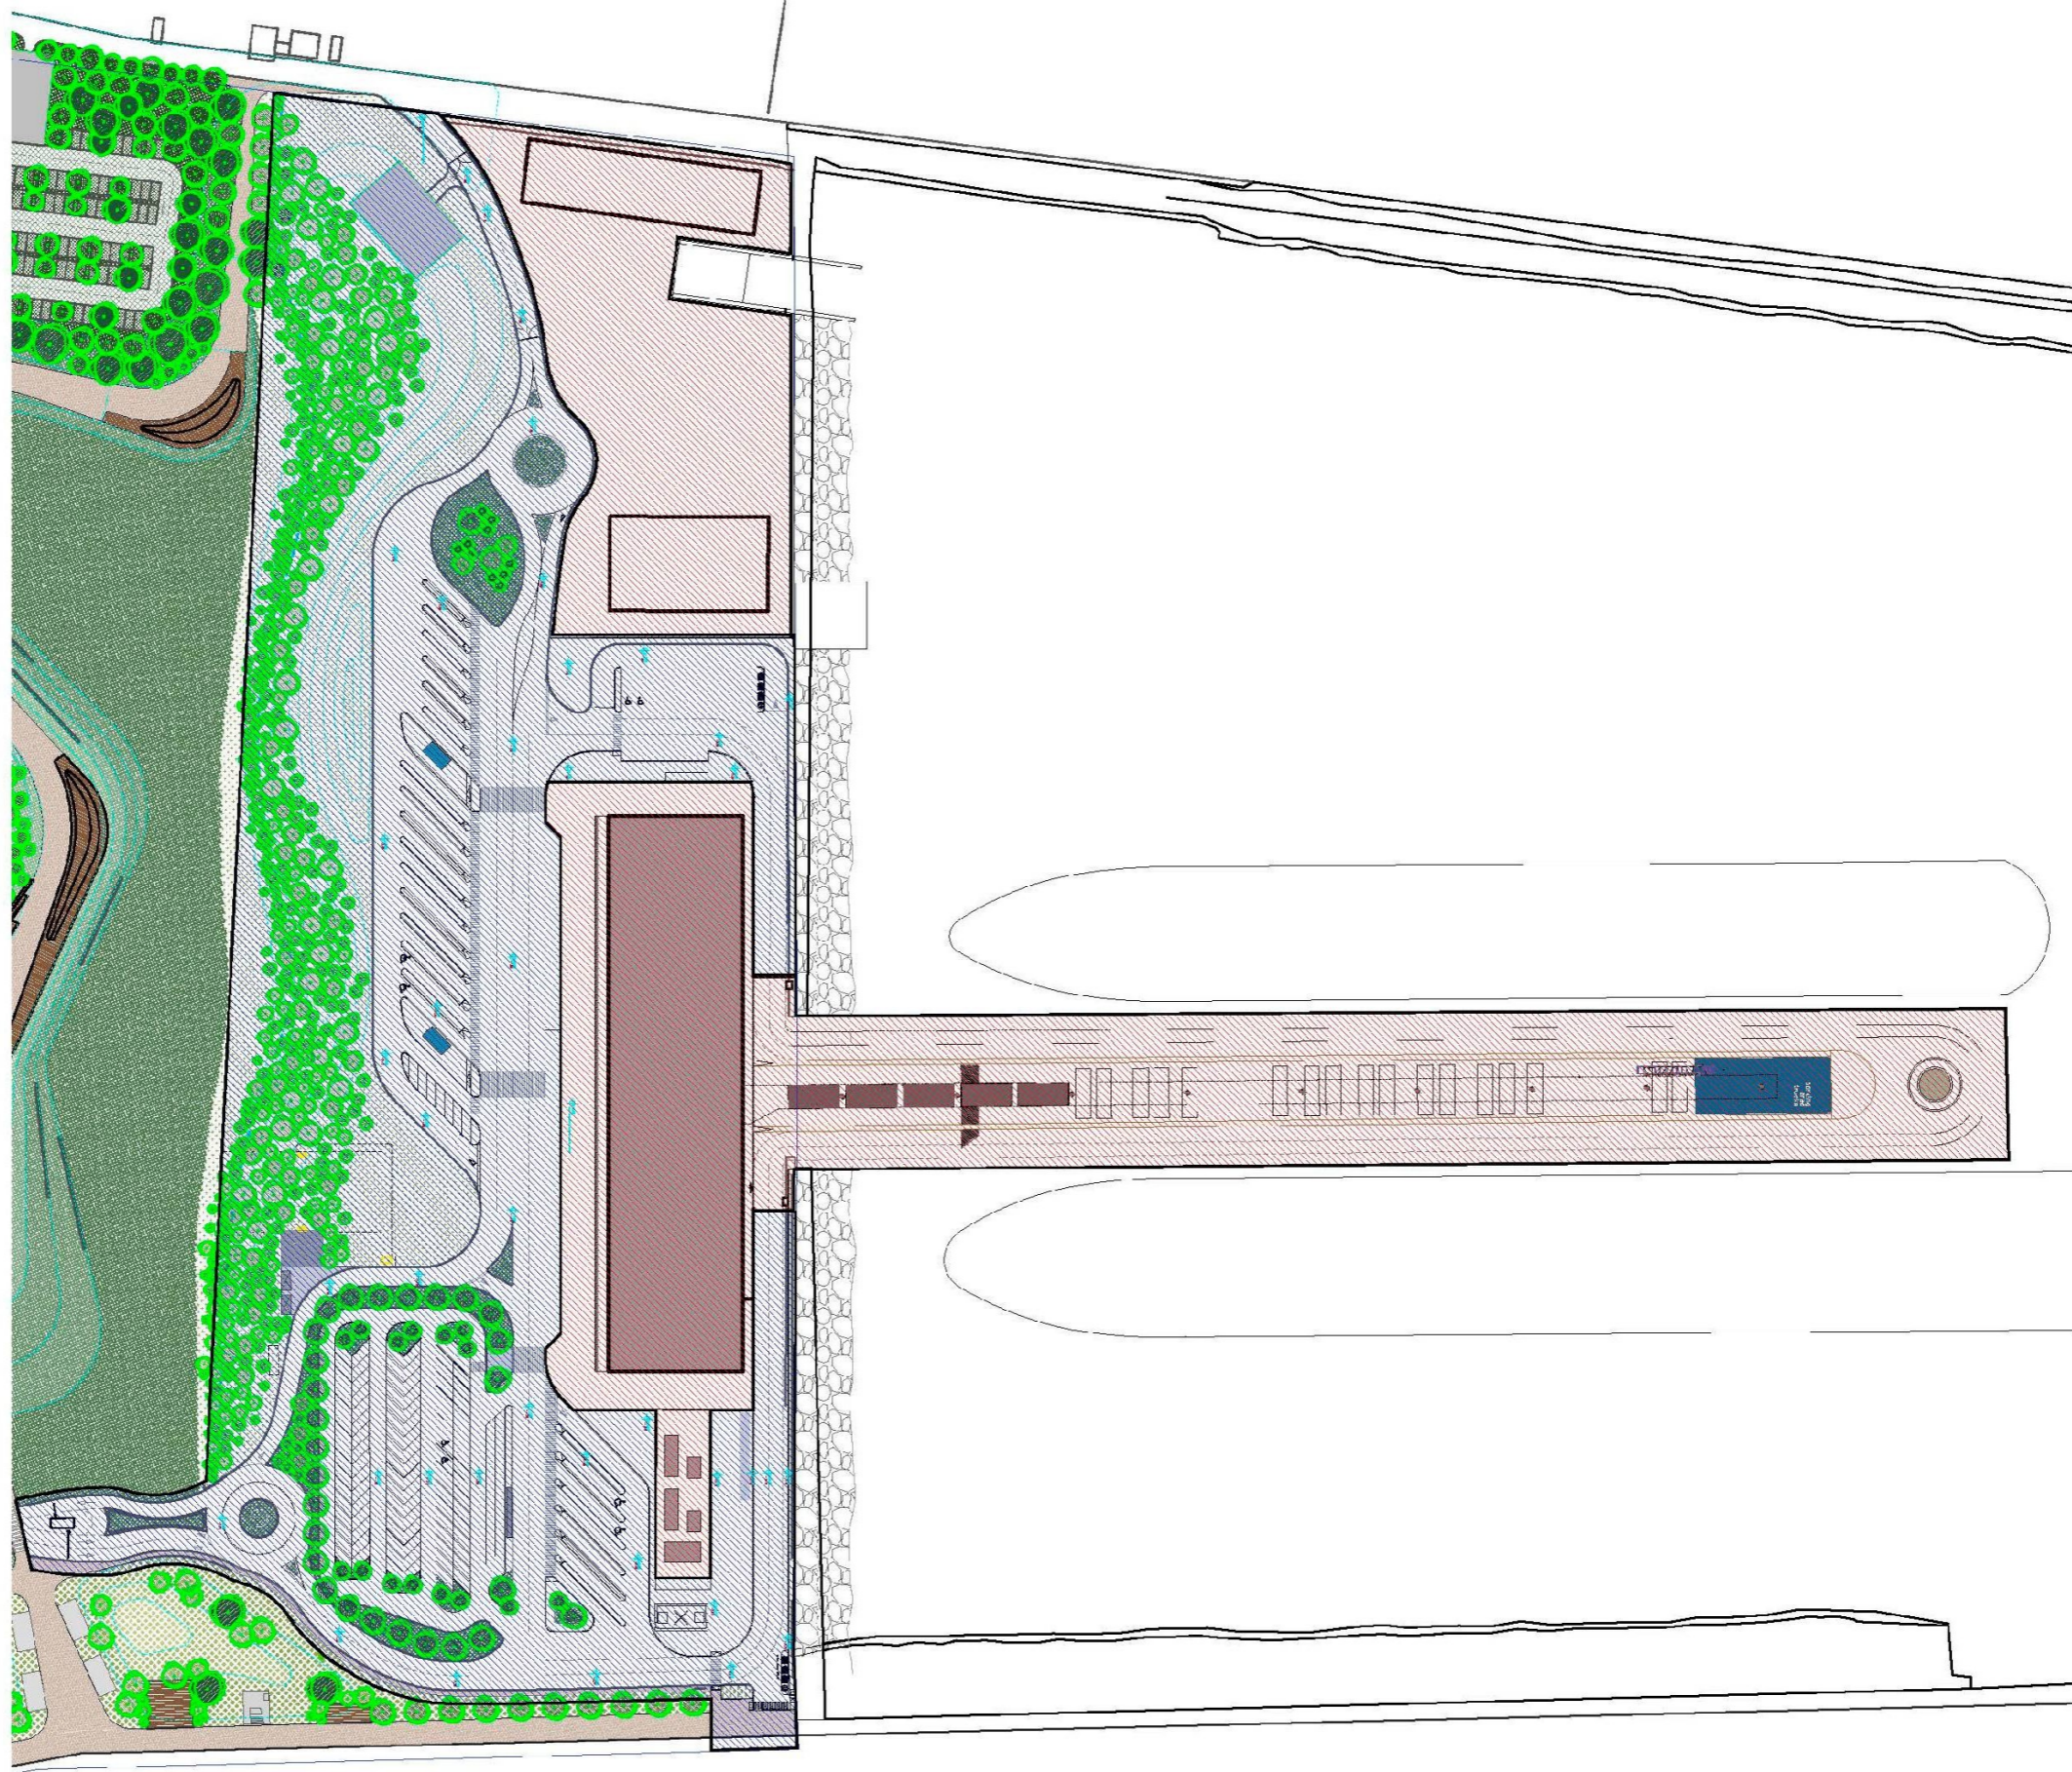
Aree oggetto di trattazione (retino blu) e non oggetto di trattazione (retino rosso)
